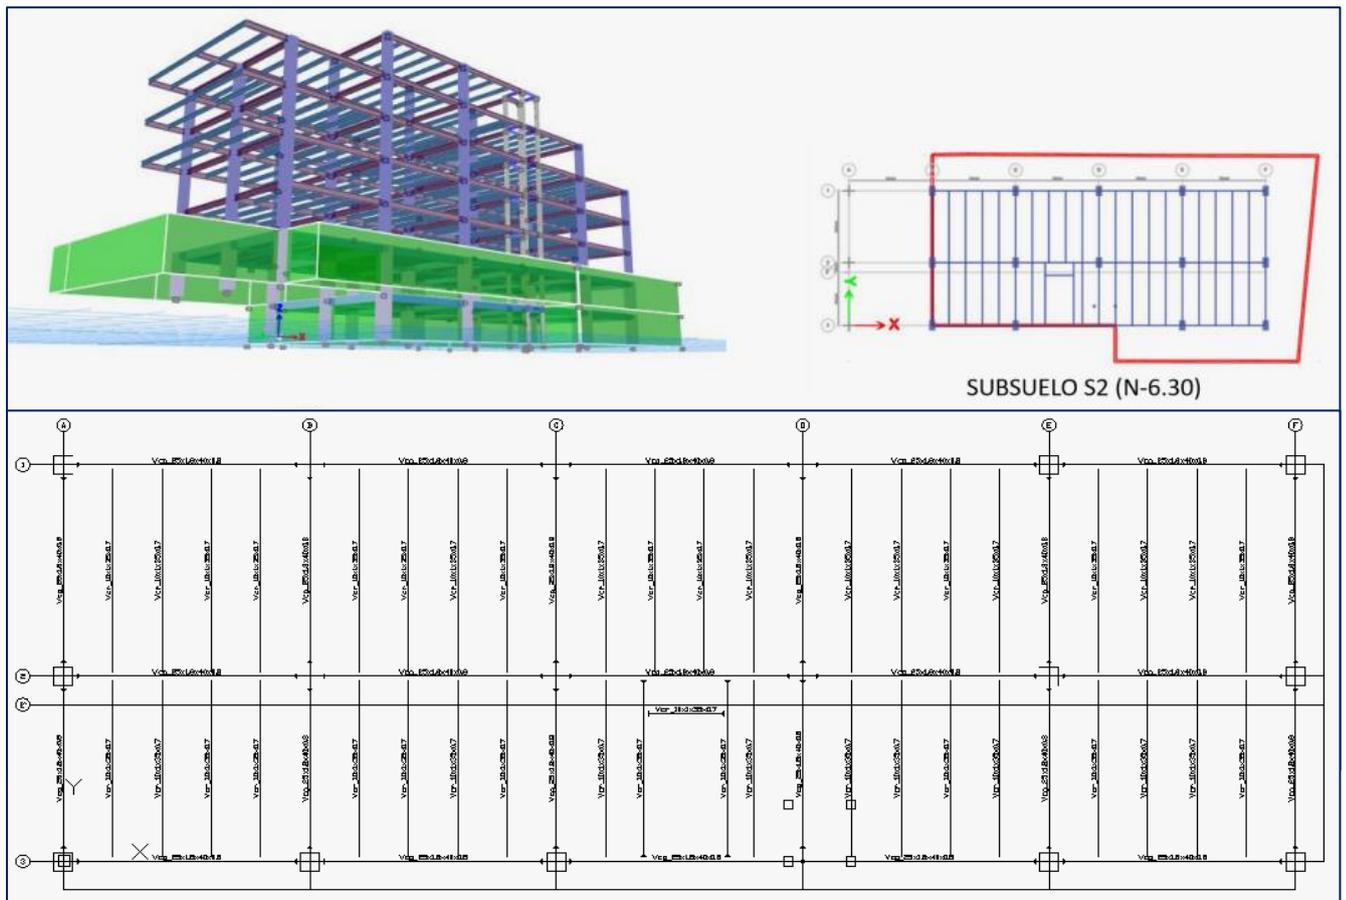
Diseño Estructural - Documentación Base Estructural
